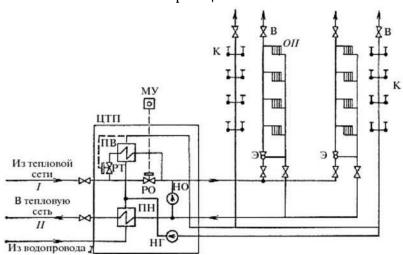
Схема присоединения отопления и горячего водоснабжения группы зданий к тепловой сети через тепловой пункт: В – воздушный кран: К – водоразборный кран; НО – насос отопления смесительный; НГ – насос горячего водоснабжения циркуляционный; ПН – подогреватель горячего водоснабжения нижней ступени; ПВ – подогреватель горячего водоснабжения верхней ступени; РТ – регулятор температуры воды; РО – регулятор температуры отапливаемых помещений; МУ – моделирующее устройство; Э – элеватор; ОП – отопительный прибор
